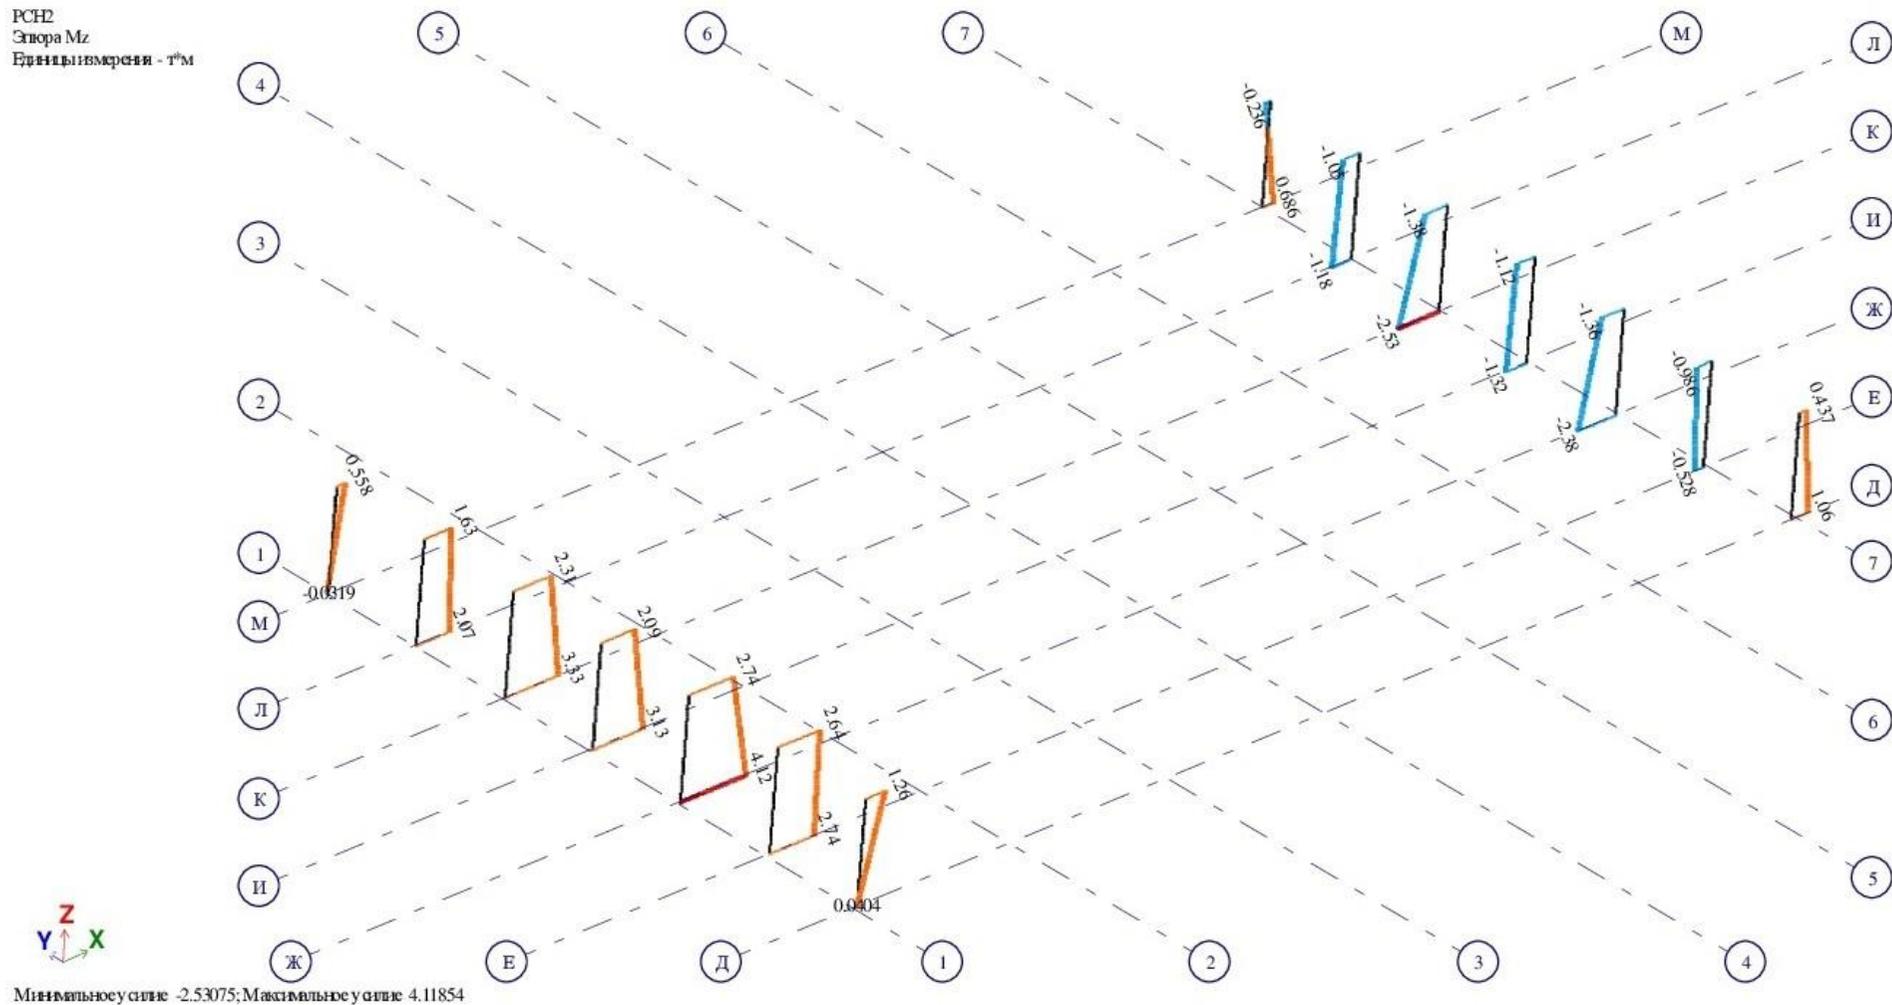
Схема нагрузок Mz на фундаменты манеж
